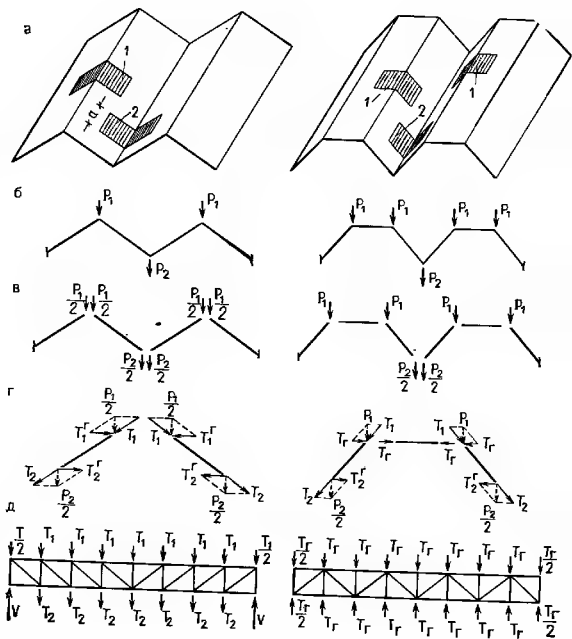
К определению нагрузок на грани решетчатых складок
